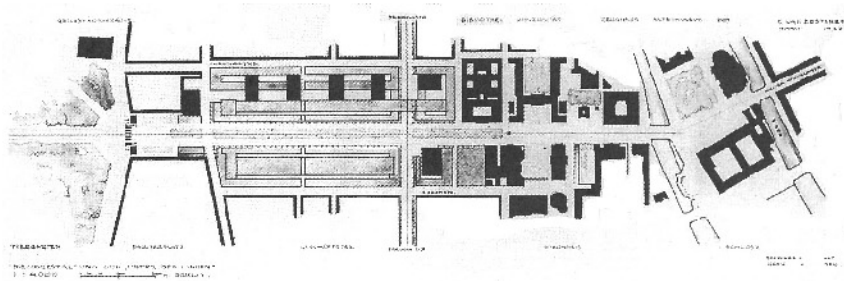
C. van Eesteren, concurso Unter den Linden, Berlín 1925. Planimetría
